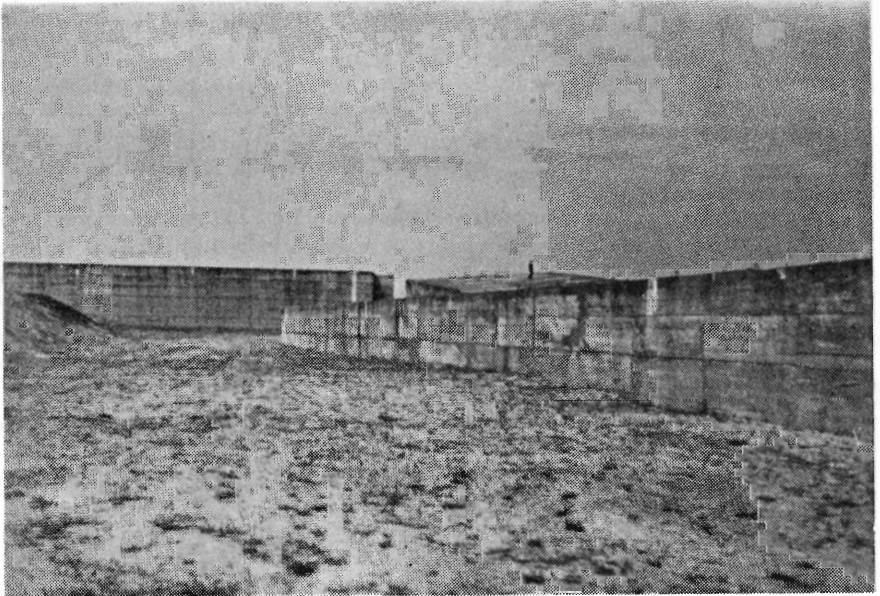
Betonkasser (Caissons) benyttet til lukning af de sidste huller i digerne. Bemærk manden. (Schouwen-Duiveland).
